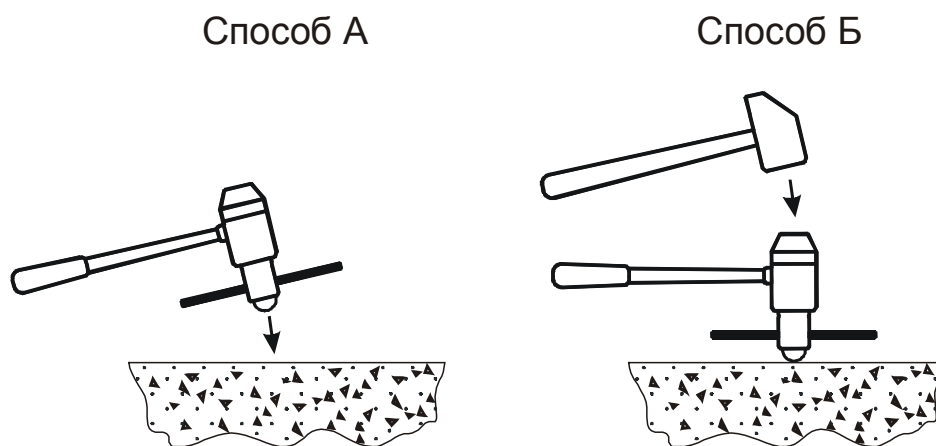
Способы испытания бетона: А – нанесение ударов эталонным молотком; Б – нанесение ударов на узких ребрах конструкций.
